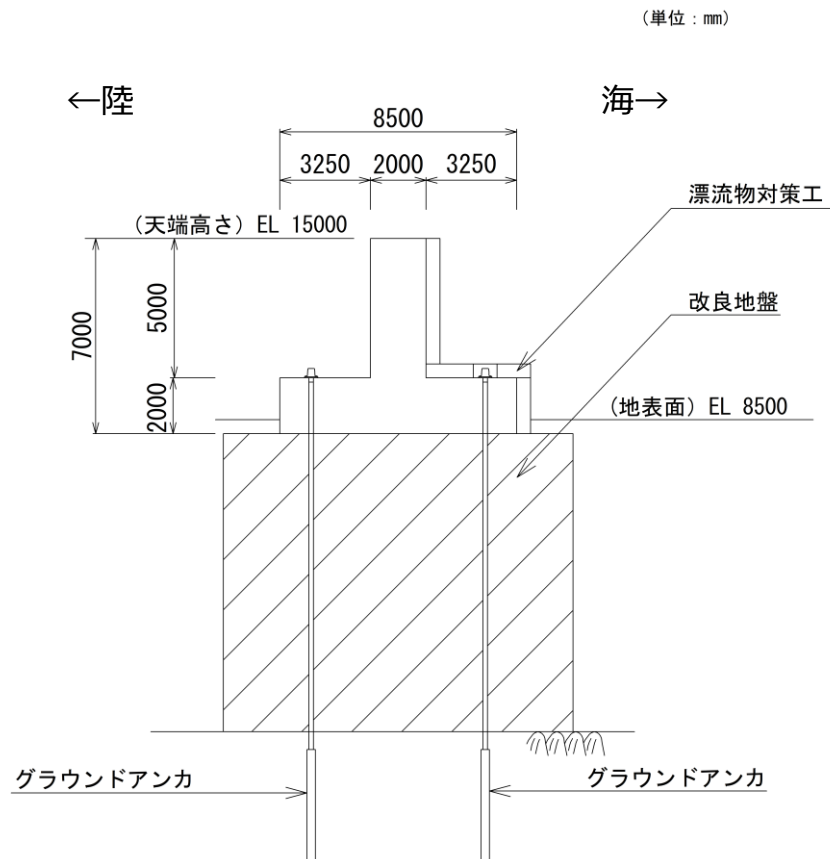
(2) 防波壁 (逆 T 擁壁) の構造図 (断面図)
